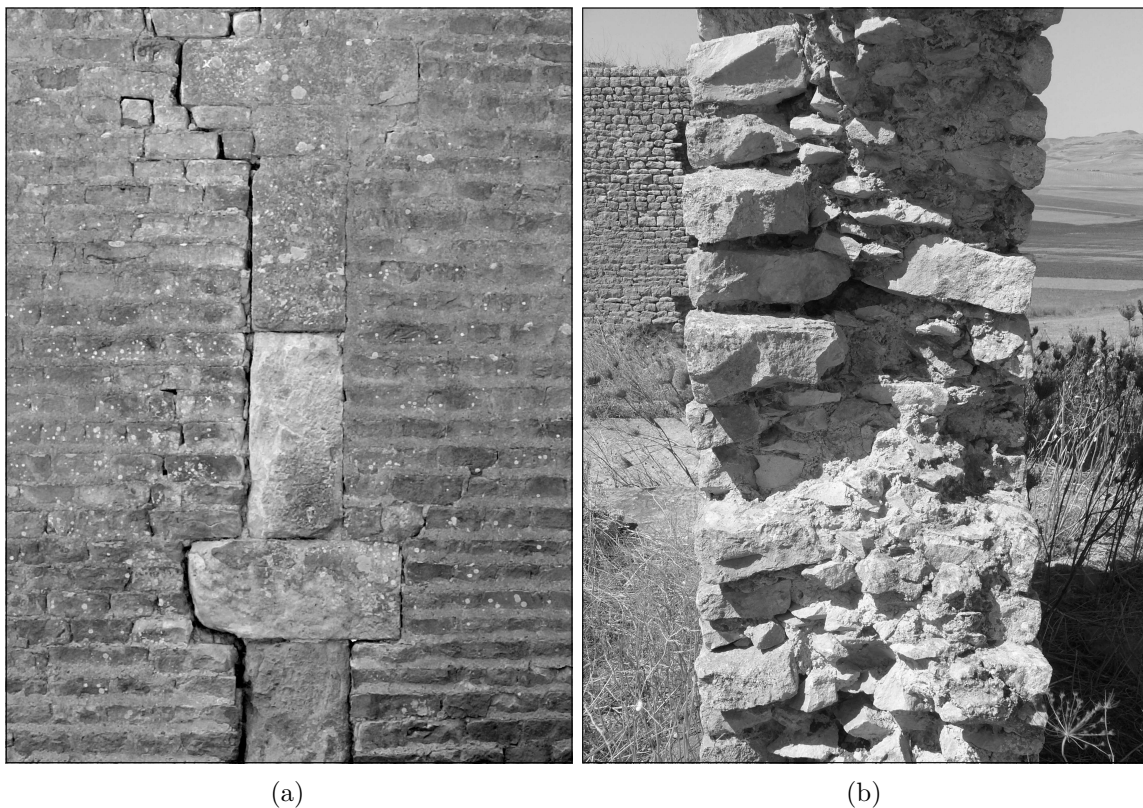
Il prospetto (a) e la sezione di un muro in *opus africanum* (foto M. de Vos)
